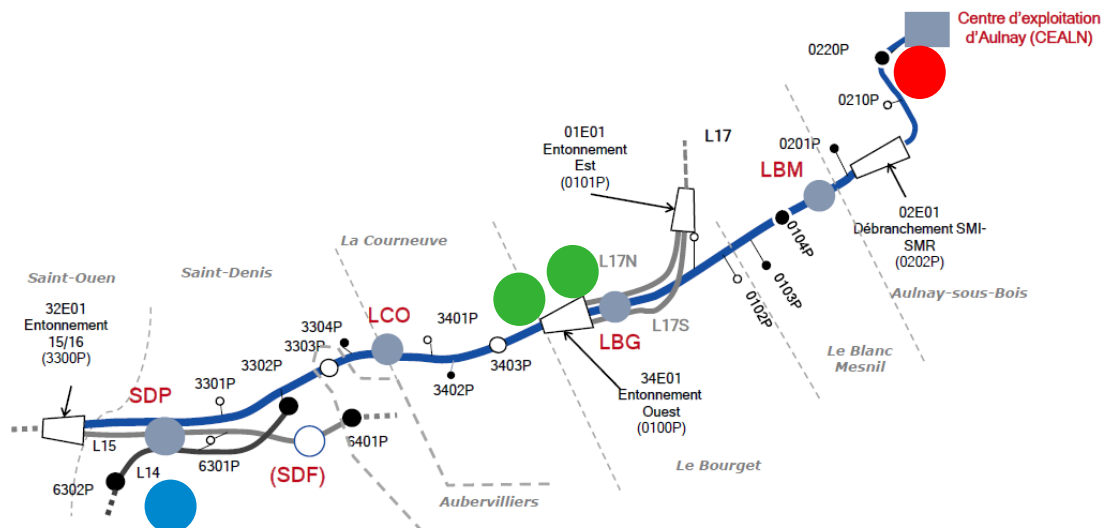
Trazado de la L16.1 con las comunas y las centrales de hormigón. Fuente: Dirección de Proyecto L16.1
